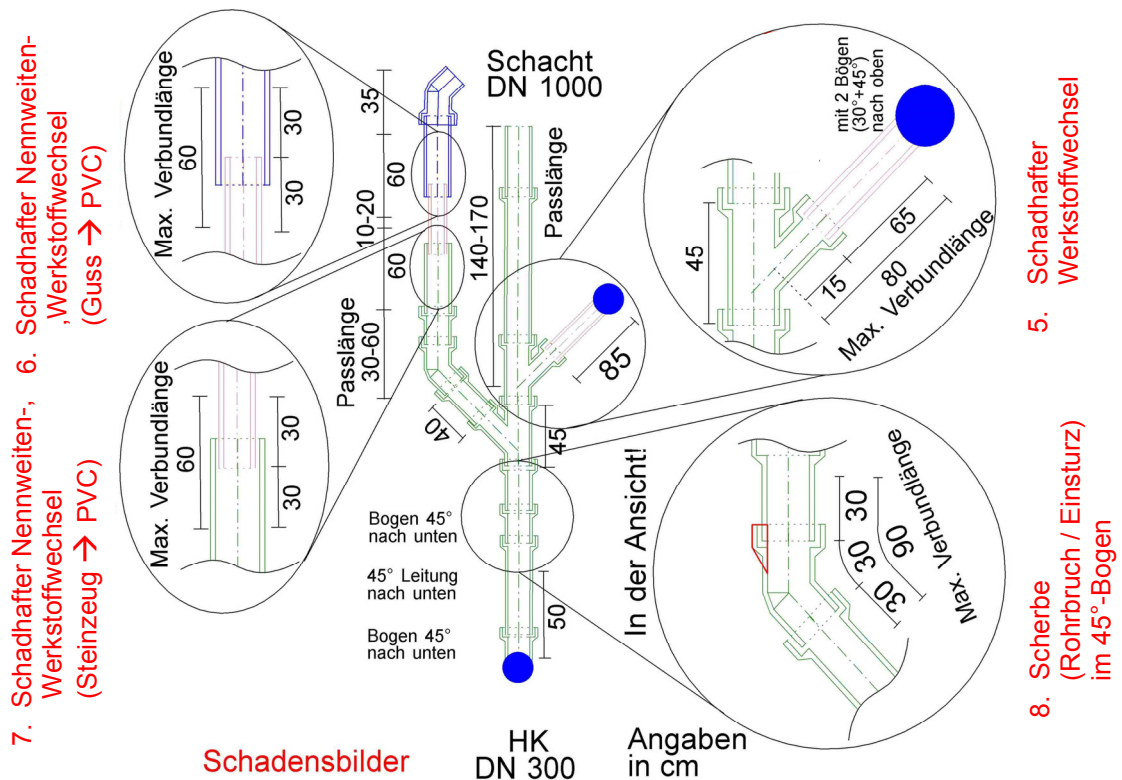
Versuchsaufbau Kurzliner: Obere Leitung (Testaufbau II)
